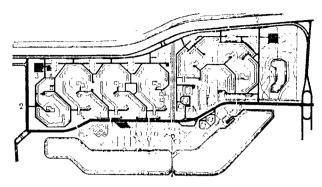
Схема размещения проездов и гаражей на территорин экспериментального жилого комплекса
